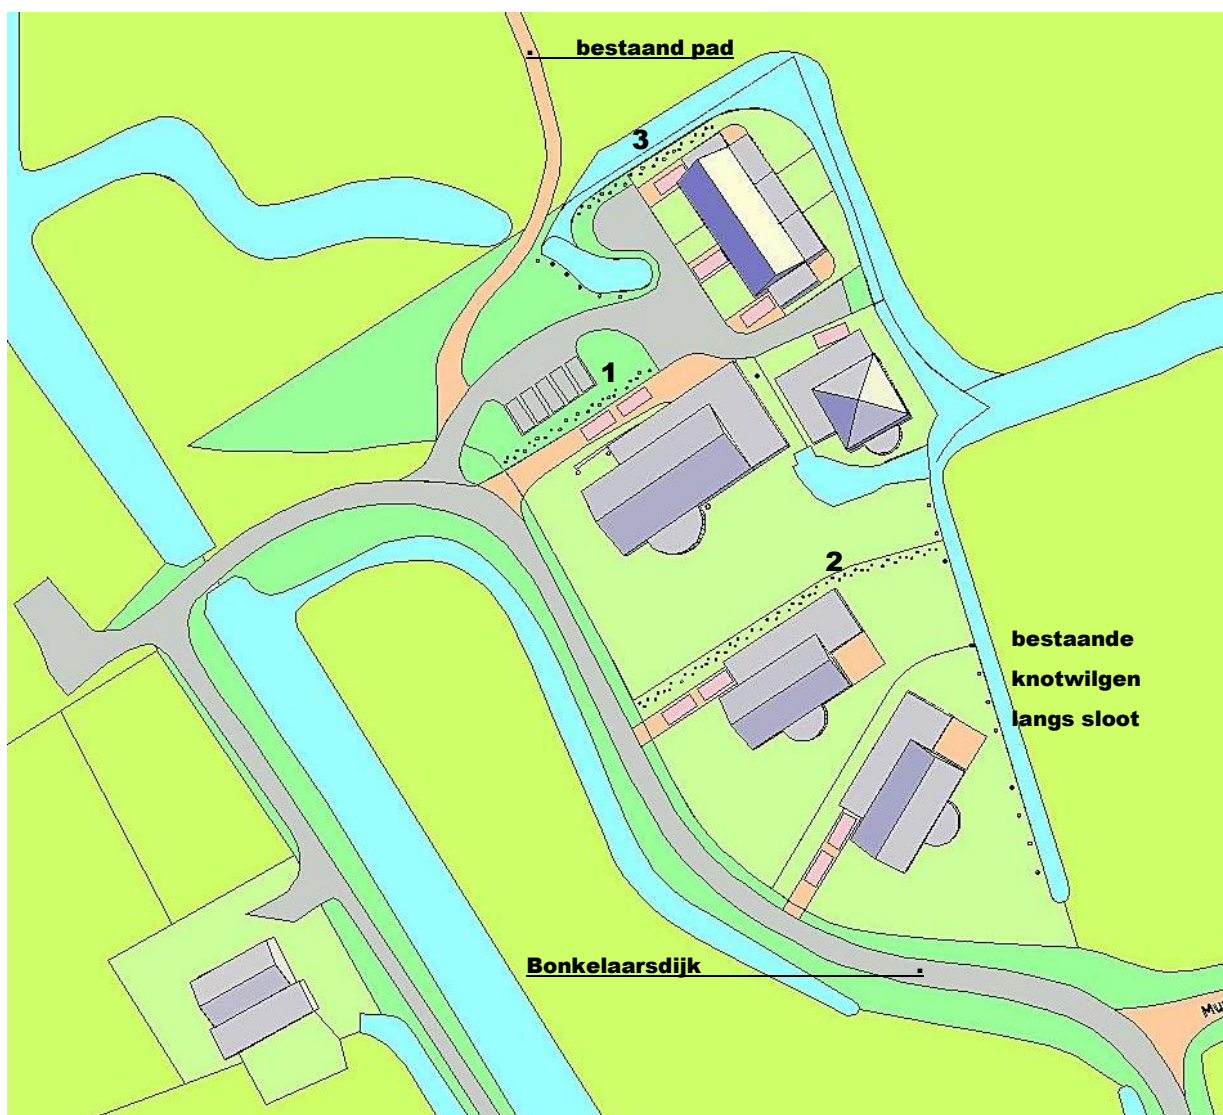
Stedenbouwkundig plan met een aanzet tot erfbebouwing en terreininrichting
